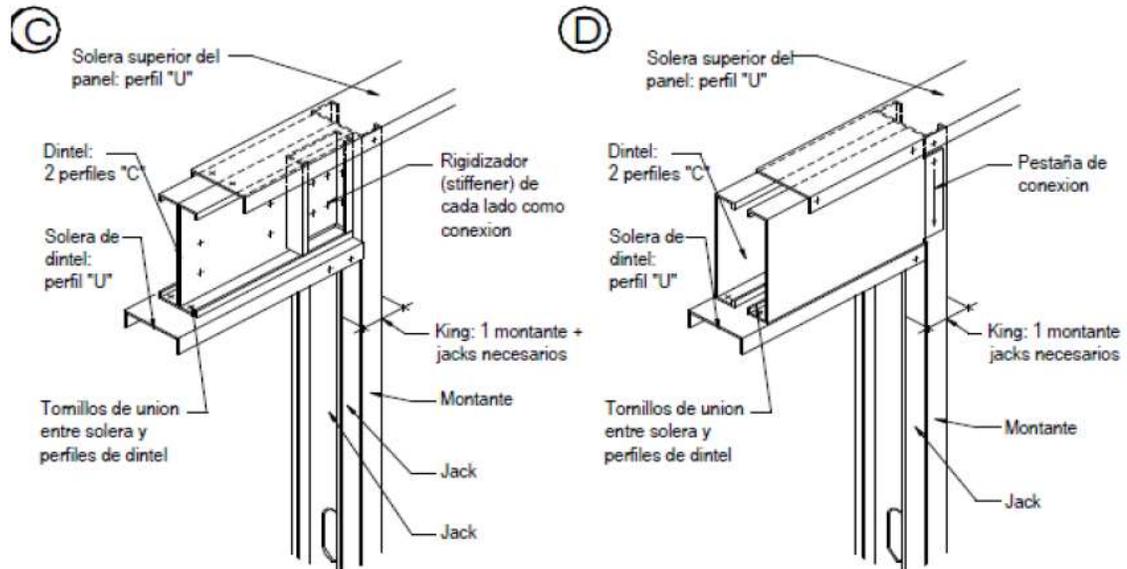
Resolución de dinteles en estructuras resueltas con Steel Framing.
